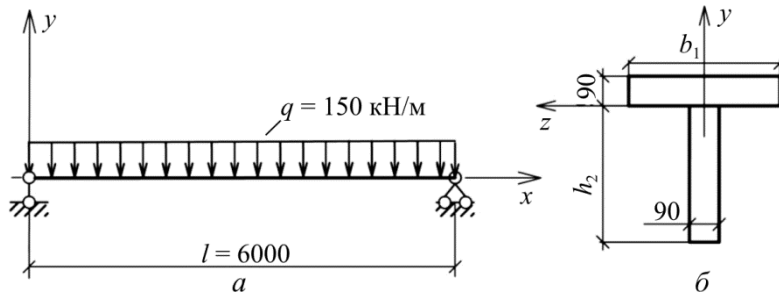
К расчету балки: *a* – расчетная схема; *б* – поперечное сечение
